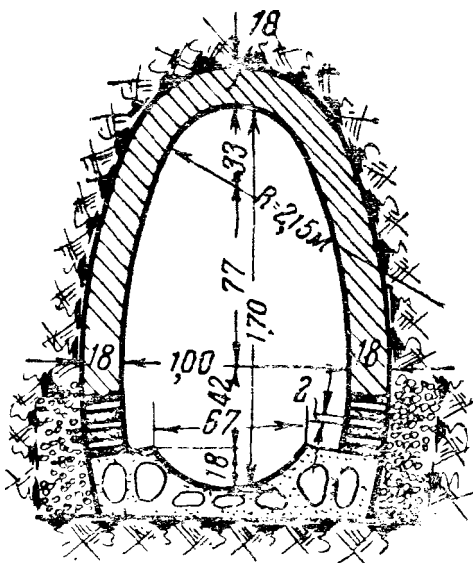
Бетонная водосборная галлерей со стоком воды по специальному лотку
